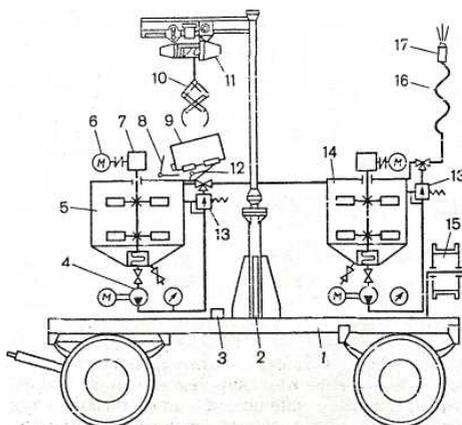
Схема передвижной станции СО-145 для устройства безрулонных кровельных покрытий
